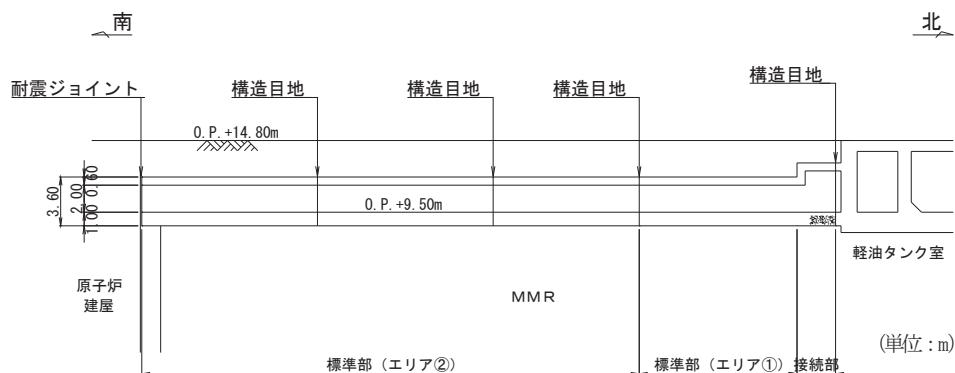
軽油タンク連絡ダクト縦断図 (C-C)
